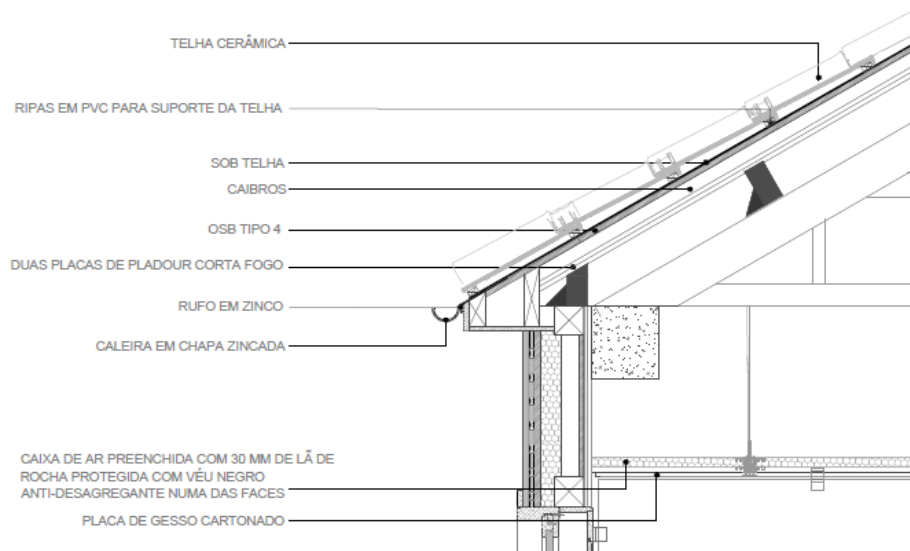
Pormenor da cobertura e teto do 3º piso [14]
